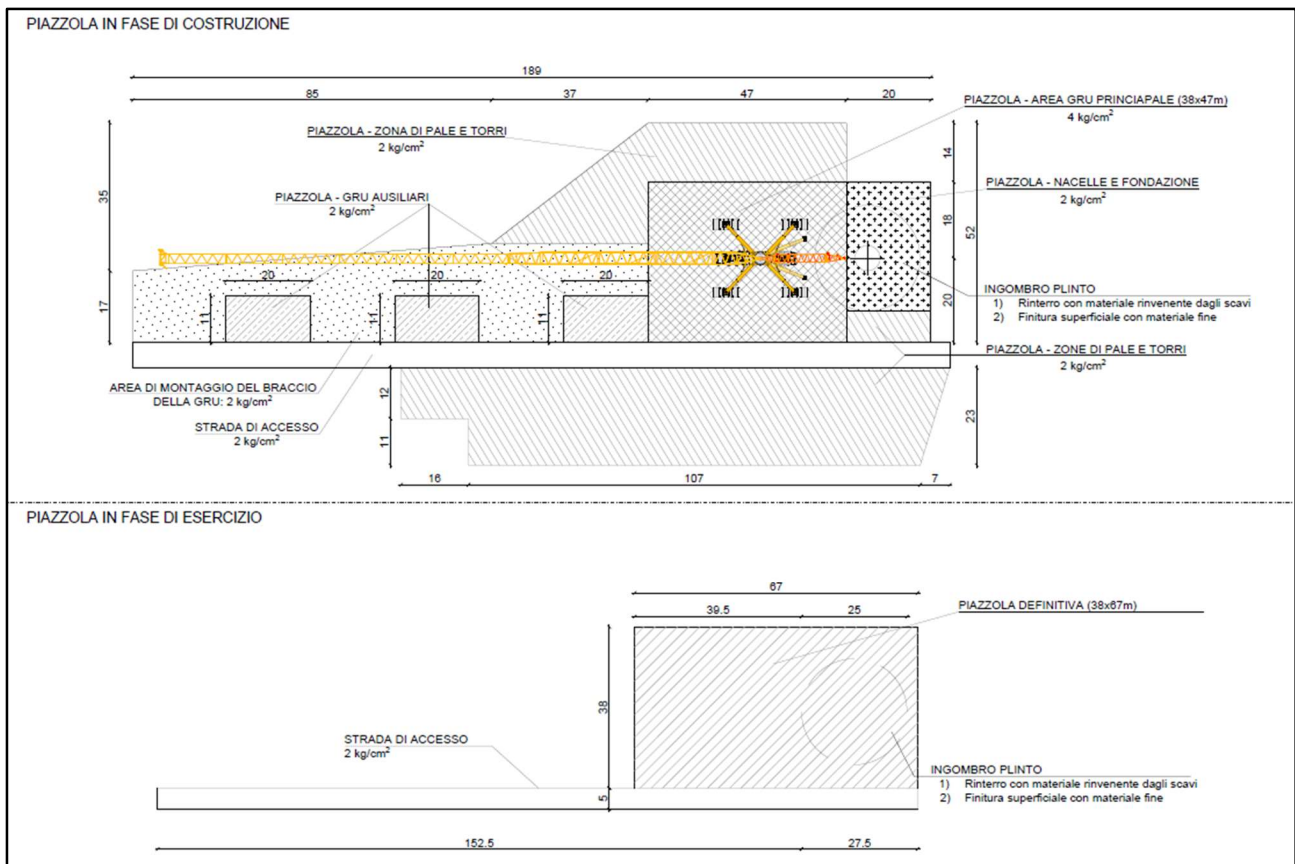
Planimetria piazzola tipo per la fase di installazione e fase di esercizio e manutenzione
